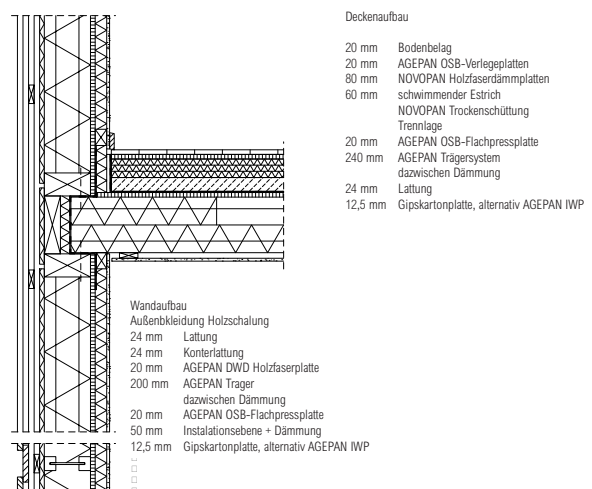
Anschlussdetail Wand - Decke AGEPAN
